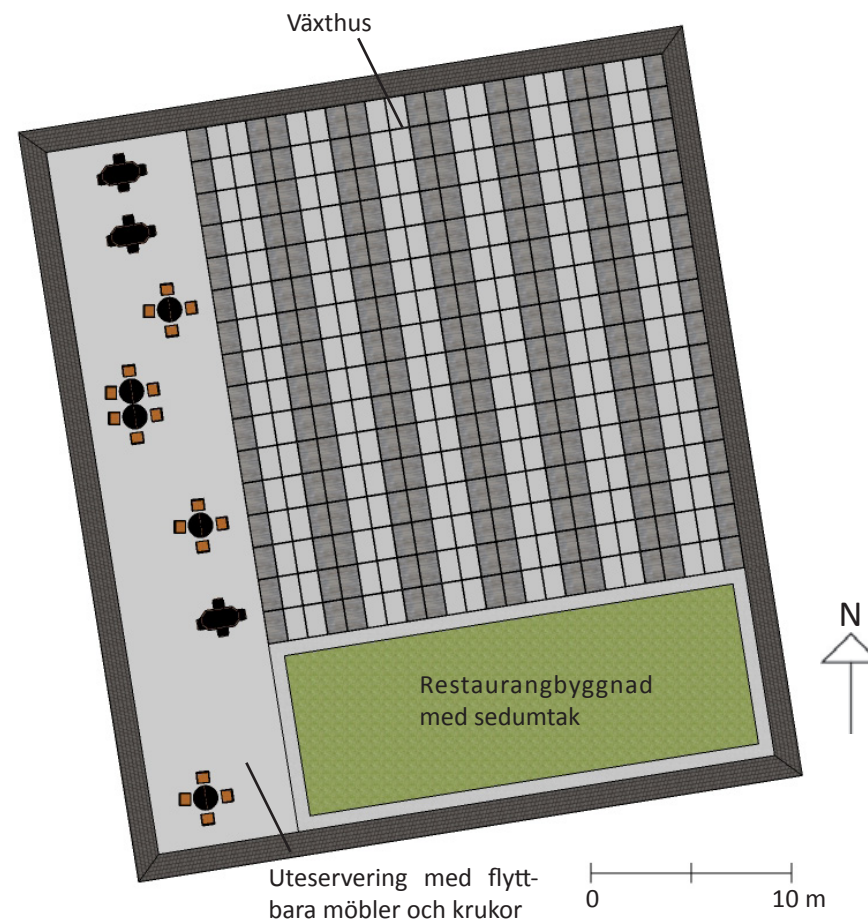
Plan över restaurangodlingen. Illustration: Fanny Jacobsson
